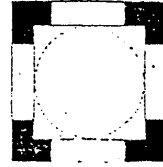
مسقط أفقي لترية يعقوب
